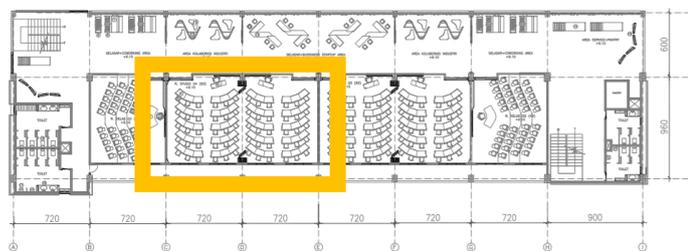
Denah Alternatif 3 Ruang Kelas
